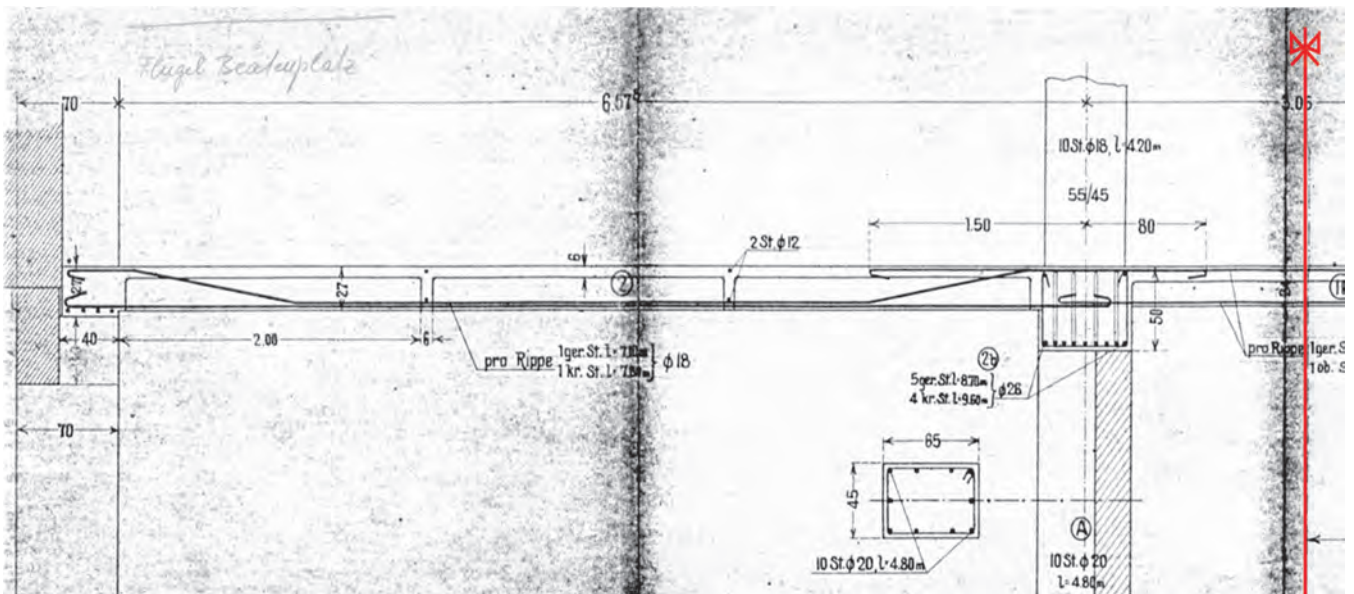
Längsschnitt der Rippendecken mit Geometrie- und Bewehrungsangaben
